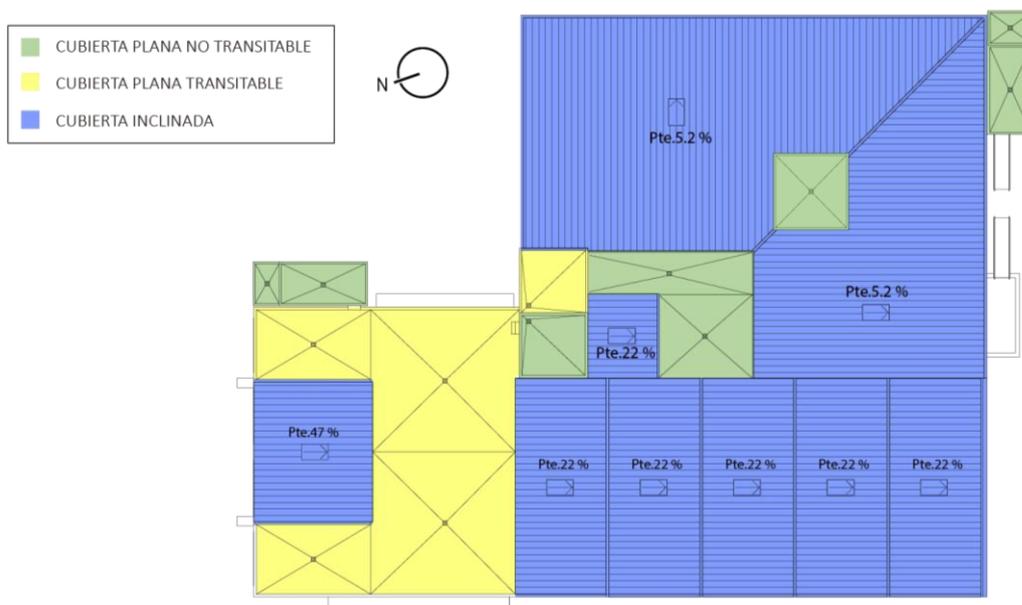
Esquema de planta de cubierta según sus tipologías. Fuente: elaboración propia
